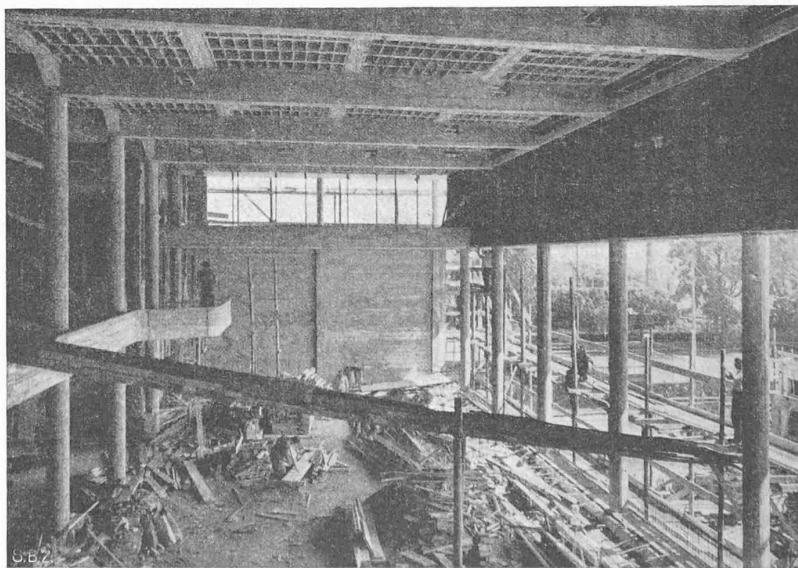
Foyertrakt im Eisenbeton-Rohbau (Seeseite rechts)
